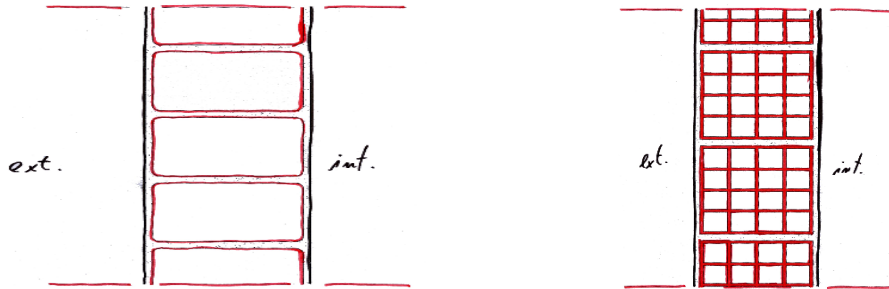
Aspecto da antiga parede simples e da subsequente parede “tijolo de 22”
